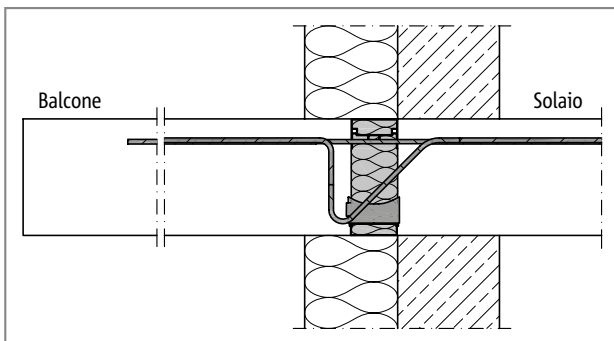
Schöck Isokorb® tipo K, raccordo con sistema di isolamento a cappotto
